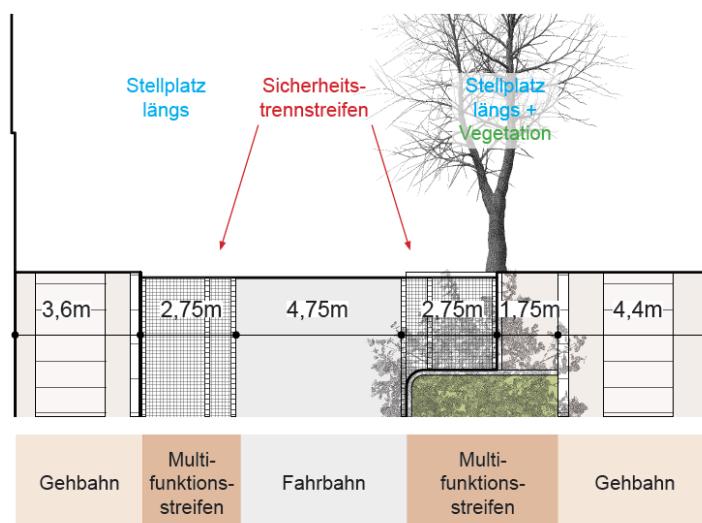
Fahrradstraße Kochstraße – Abschnitte mit Baumbestand, Prinzipschnitt mit Draufsicht
